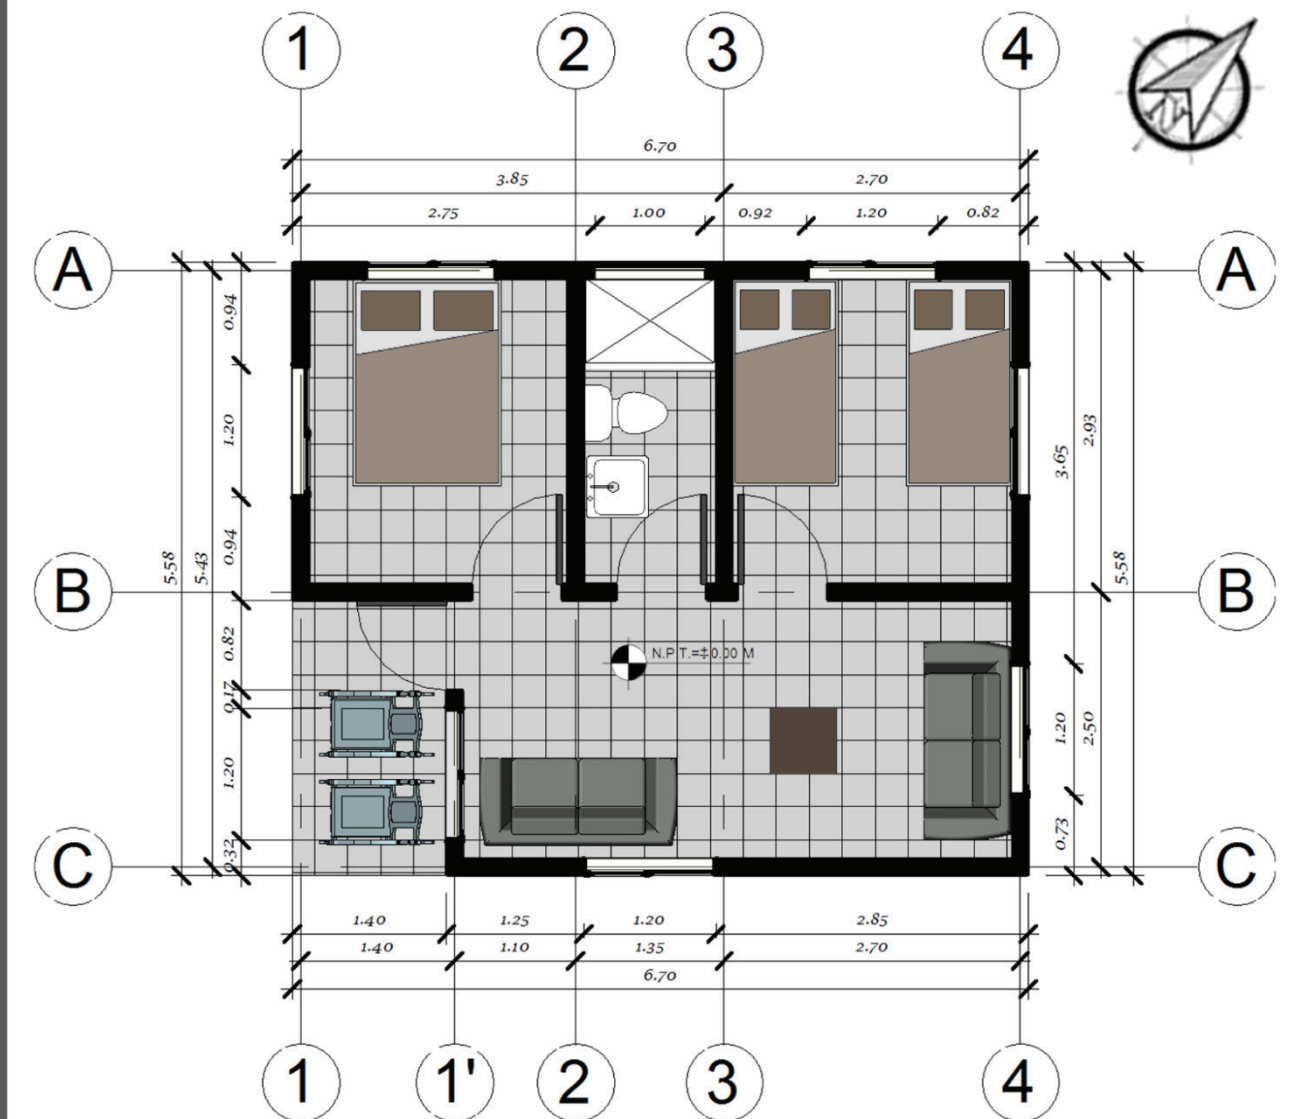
Plano arquitectónico de Cabañas Familiares.
